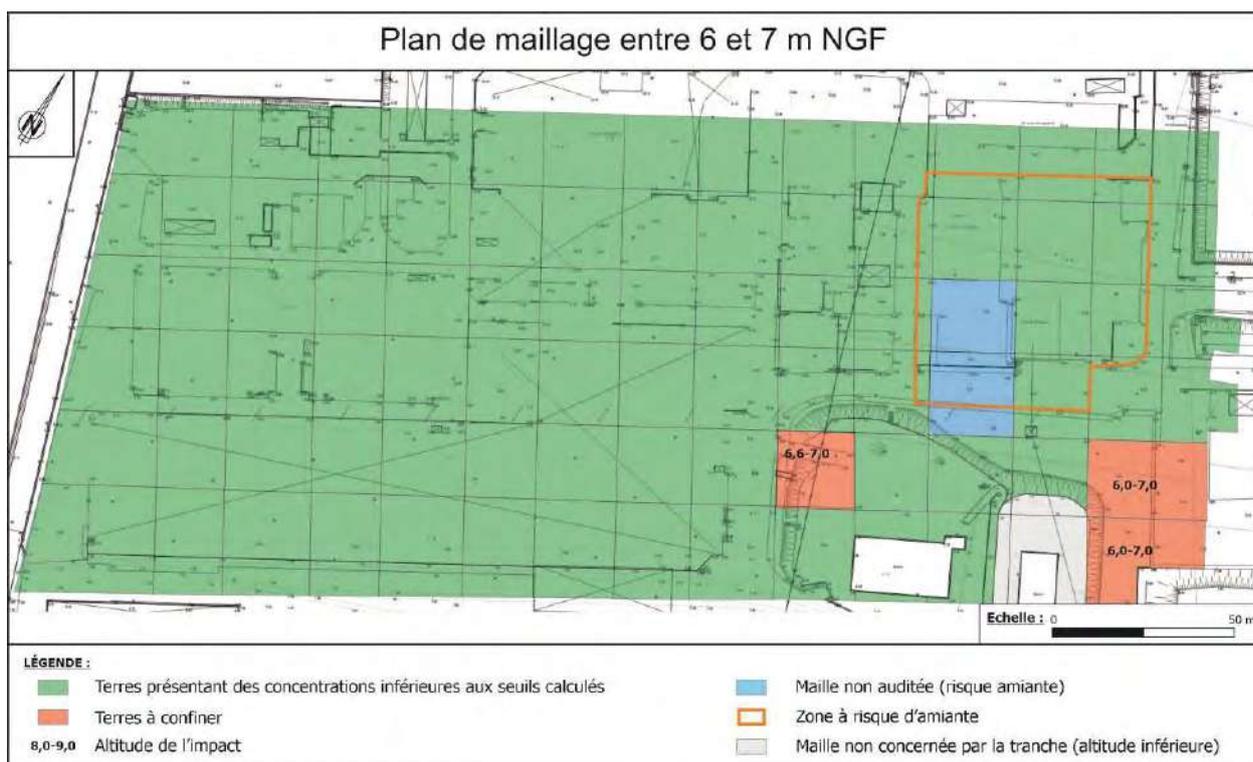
Plan de maillage entre 6 et 7 m NGF
